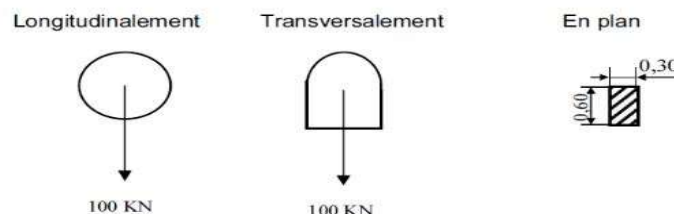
Disposition système Br pour calcul poinçonnement de la dalle
